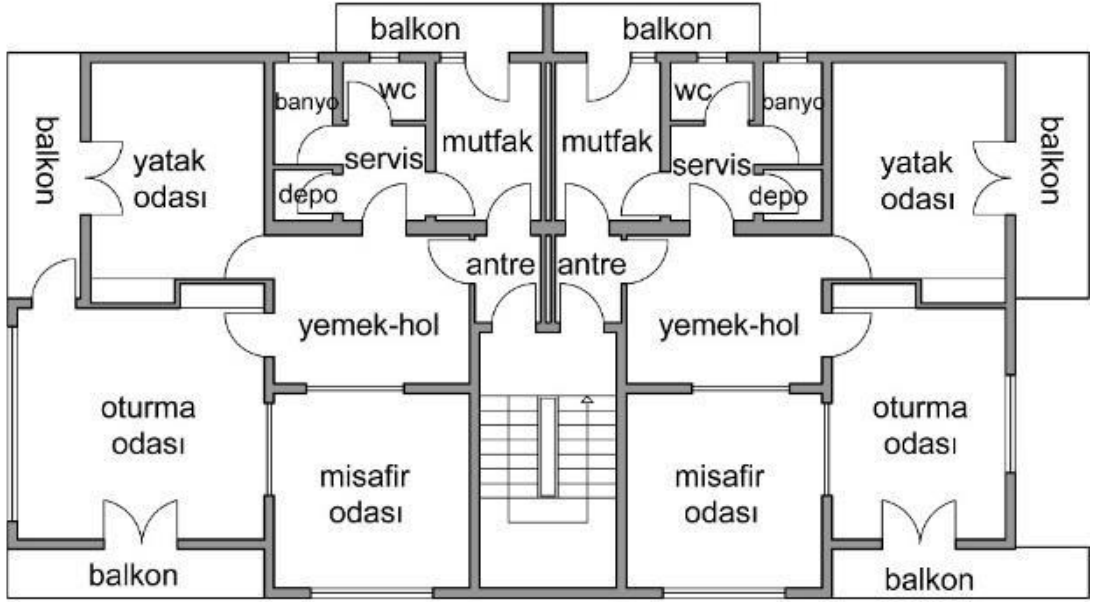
Tapan Apartmanı Planı (Yıldırım, 2018)
